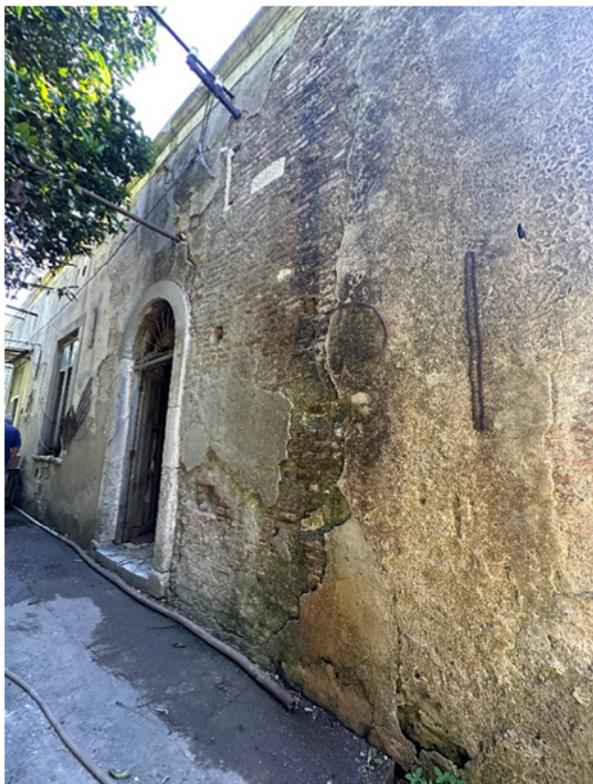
particolare della facciata , da ristrutturare – piano terra -
